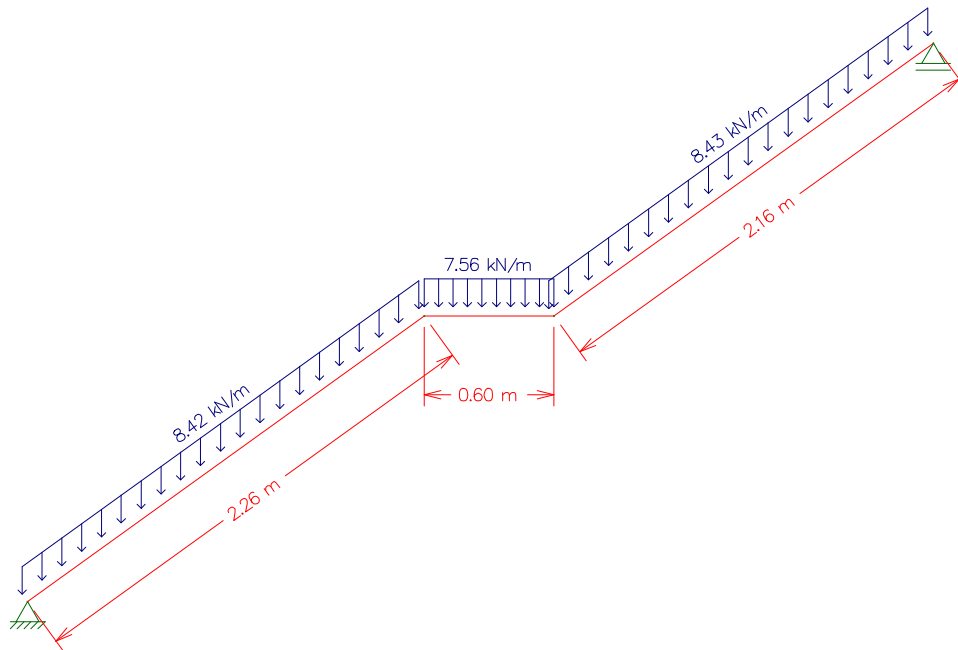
Esquema de Cálculo da Escada Adotado.
